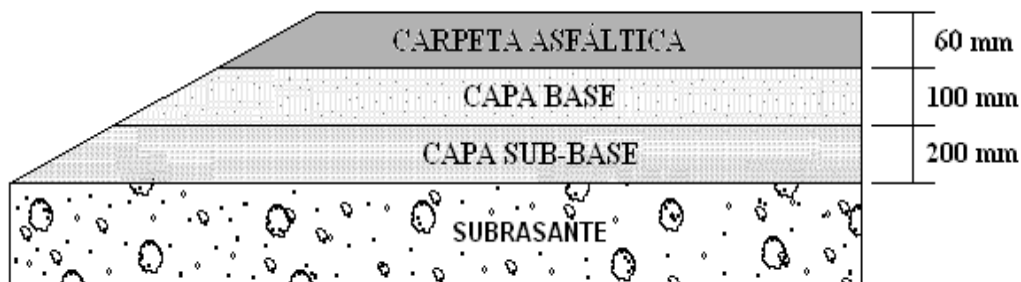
Esquema de la estructura final del pavimento tramo I.
